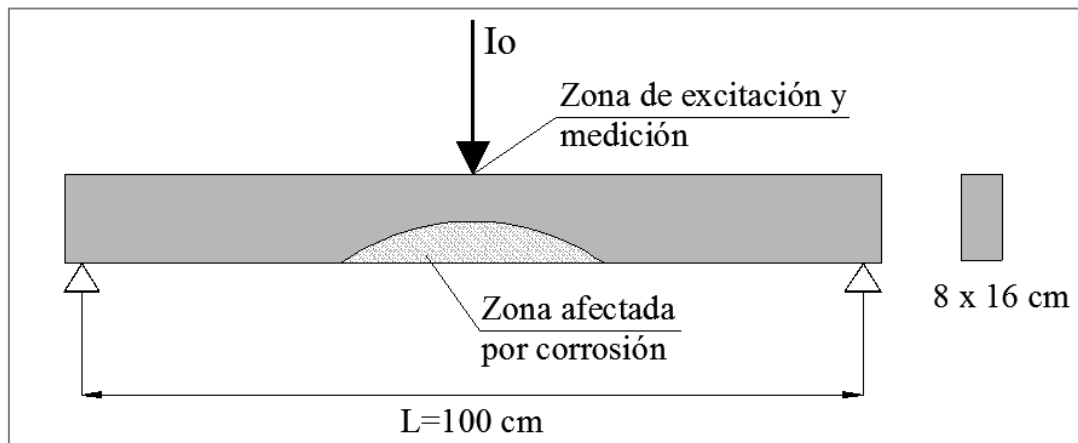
Detalle de la viga y ubicación de la zona afectada por la corrosión.
